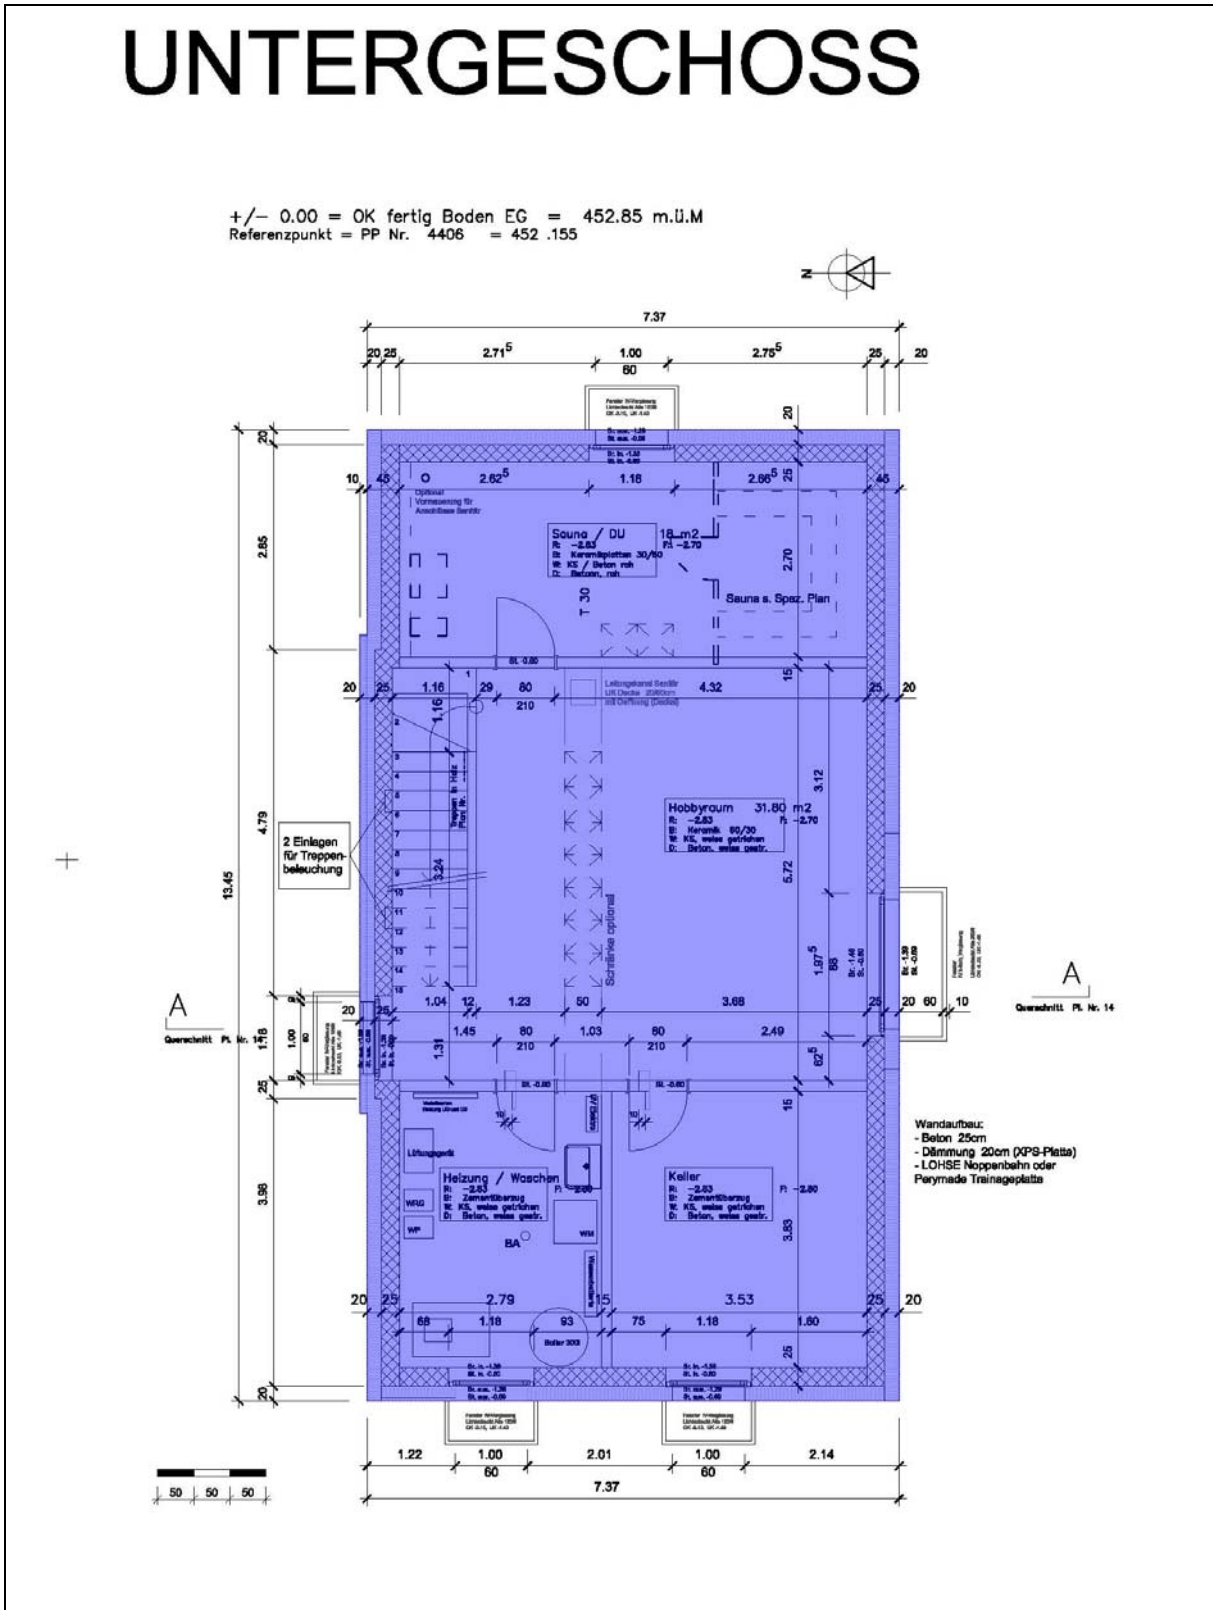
Grundrissplan EFH Untergeschoss
